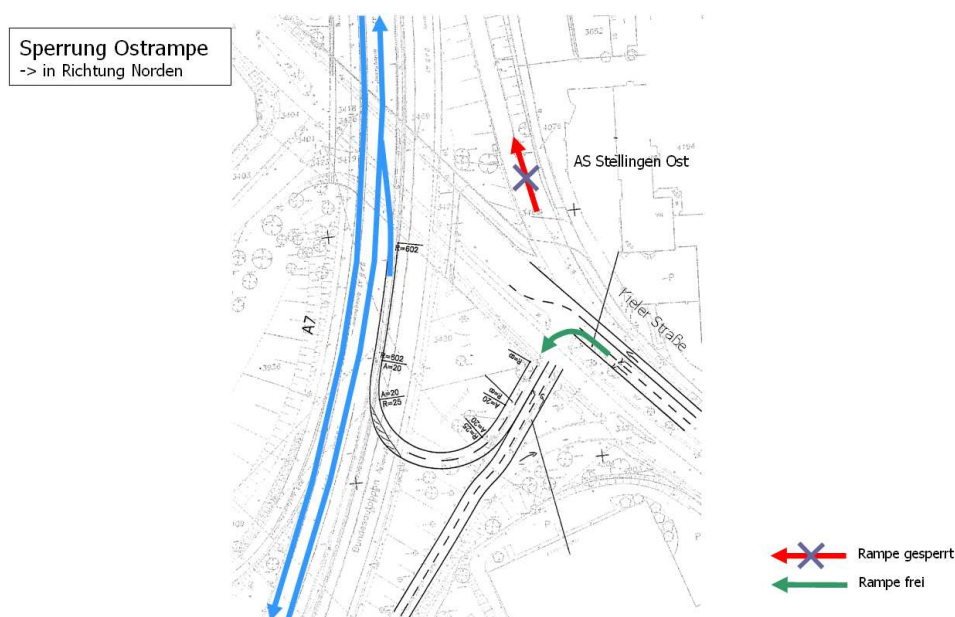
geplante Rampensperrungen AS HH-Stellungen
